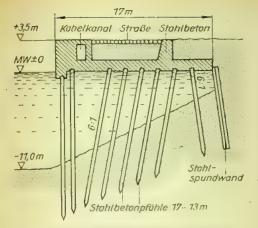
Stahlbetonplatte auf Pfahlrost
